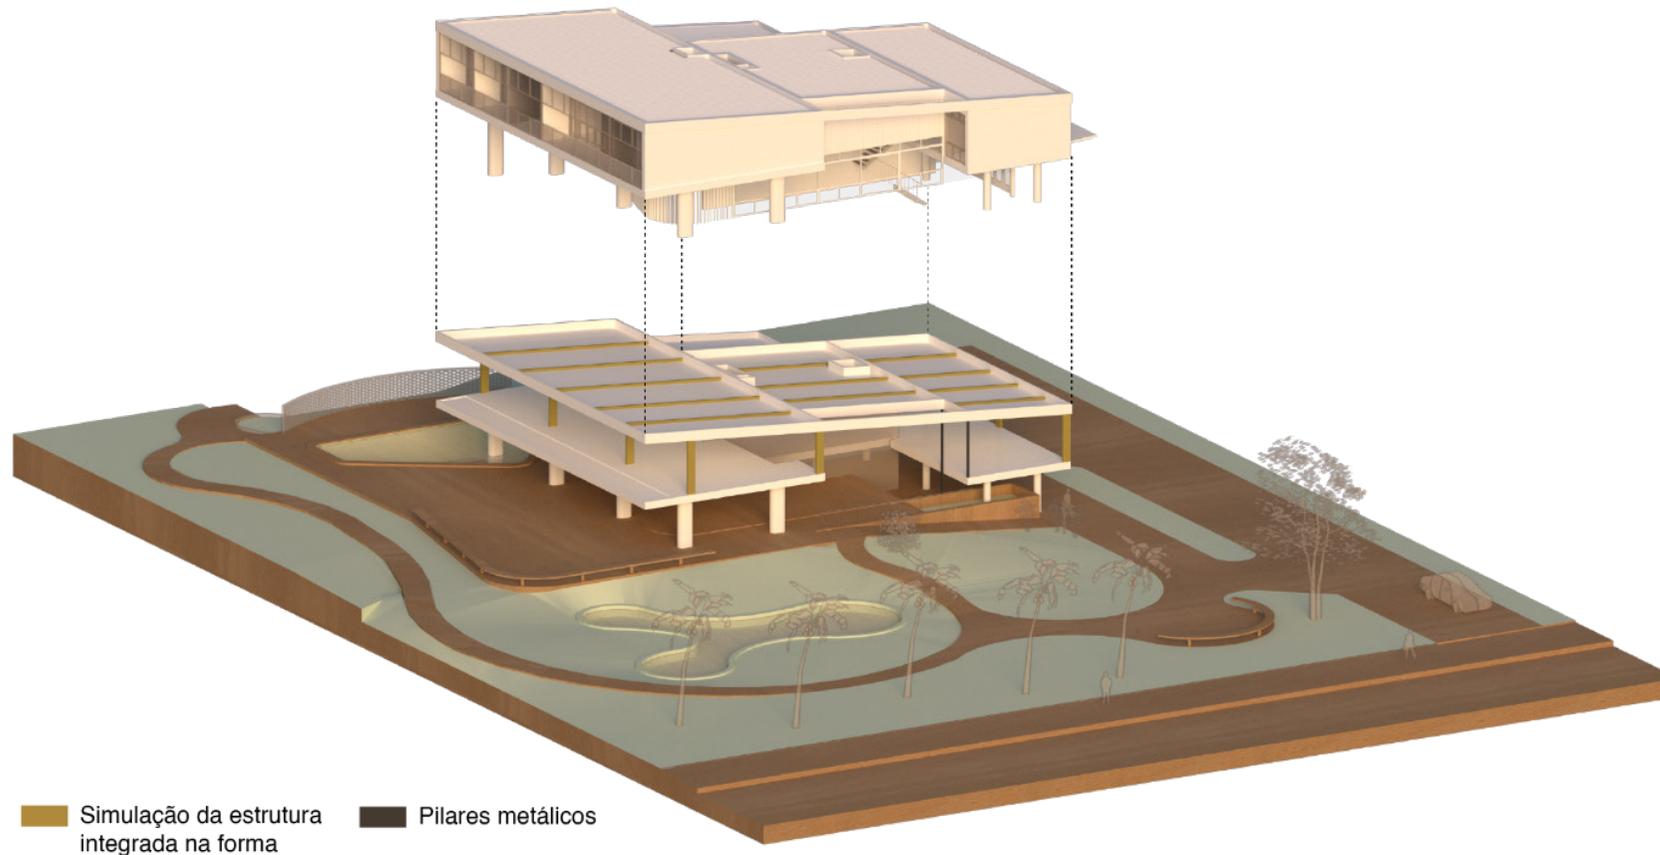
Pavimento superior mais fechado em relação ao pavimento térreo.
